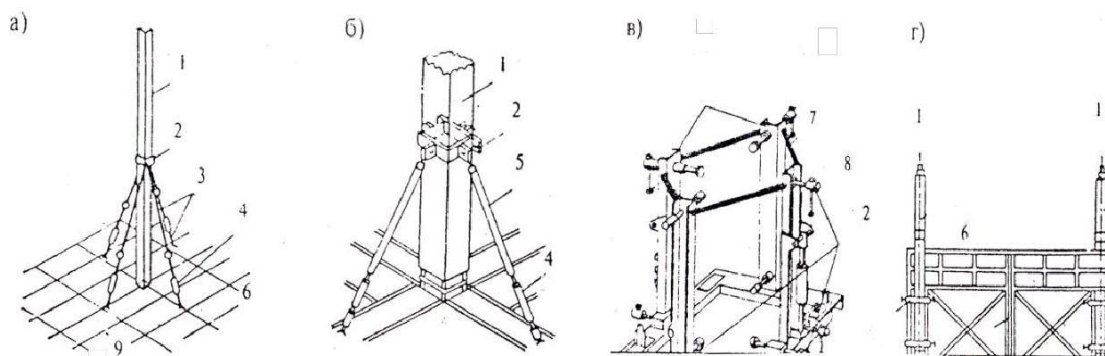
способы временного крепления железобетонных колонн многоэтажных зданий:
